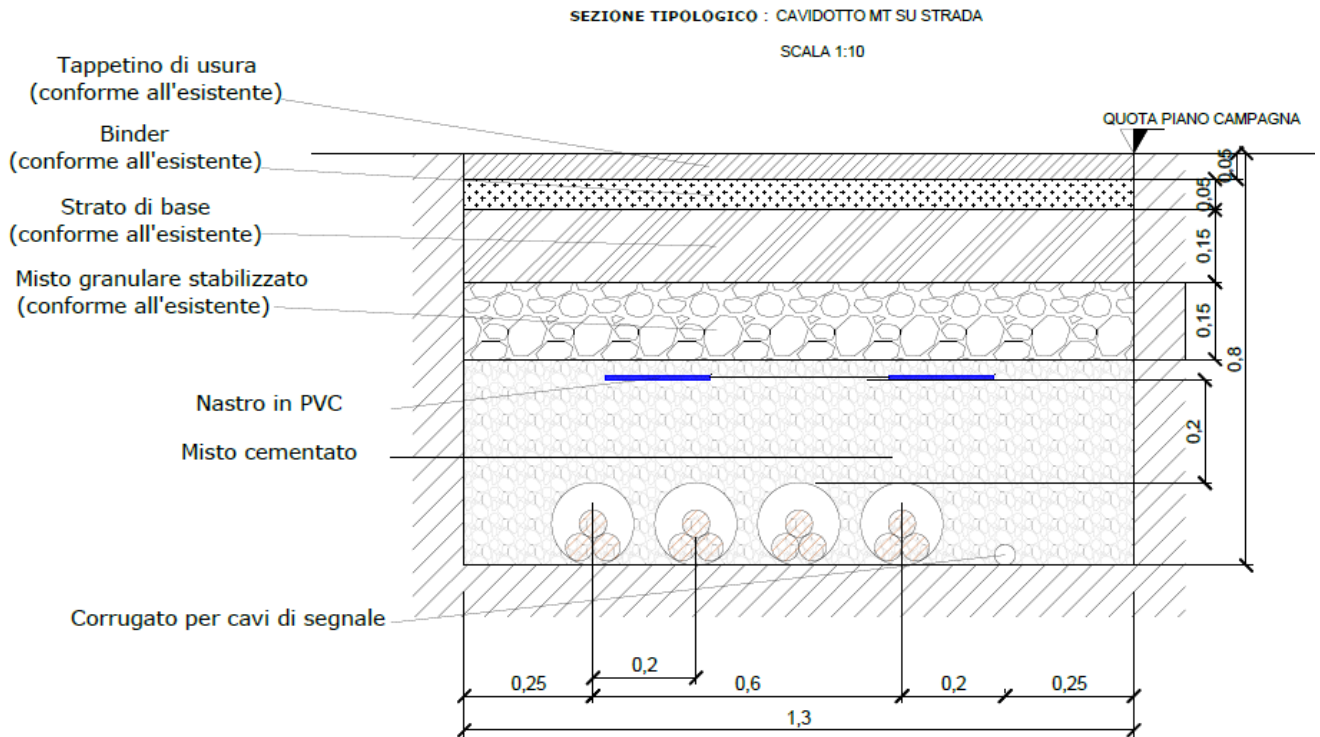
Sezione tipo posa con cavi direttamente interrati su strada
